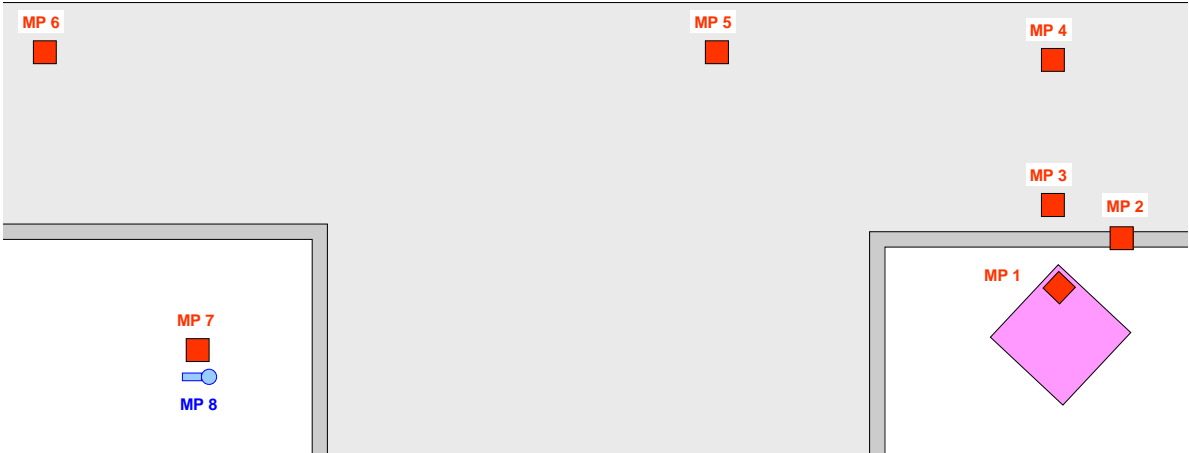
Position der Messpunkte im Grundriss
